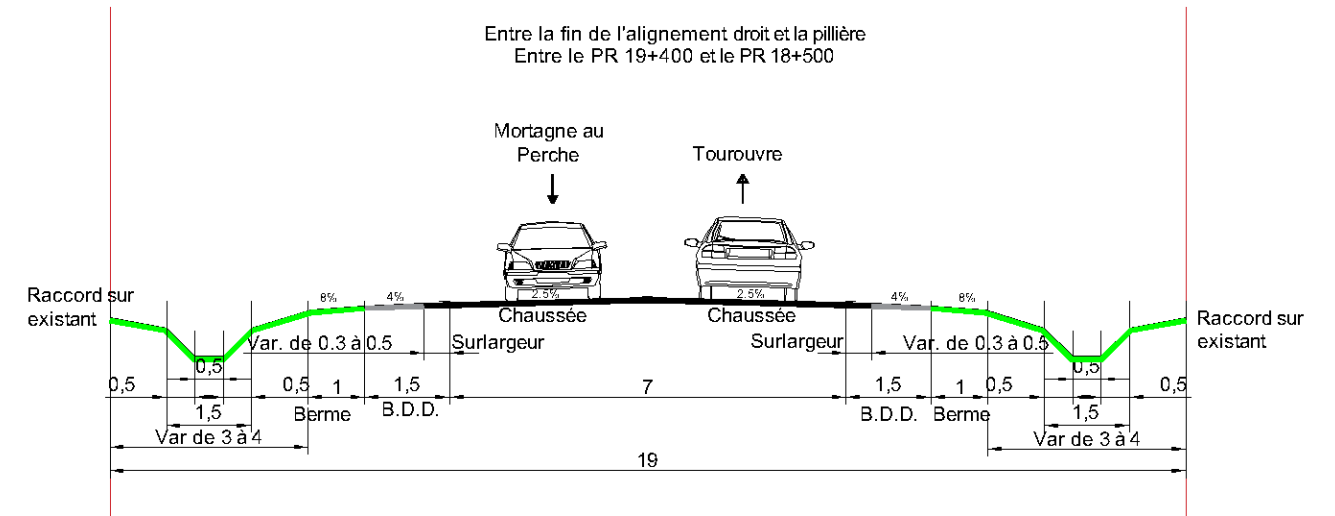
Profils en travers type - Entre la fin de l'alignement droit et " La Pilière " (source: SEGIC)
